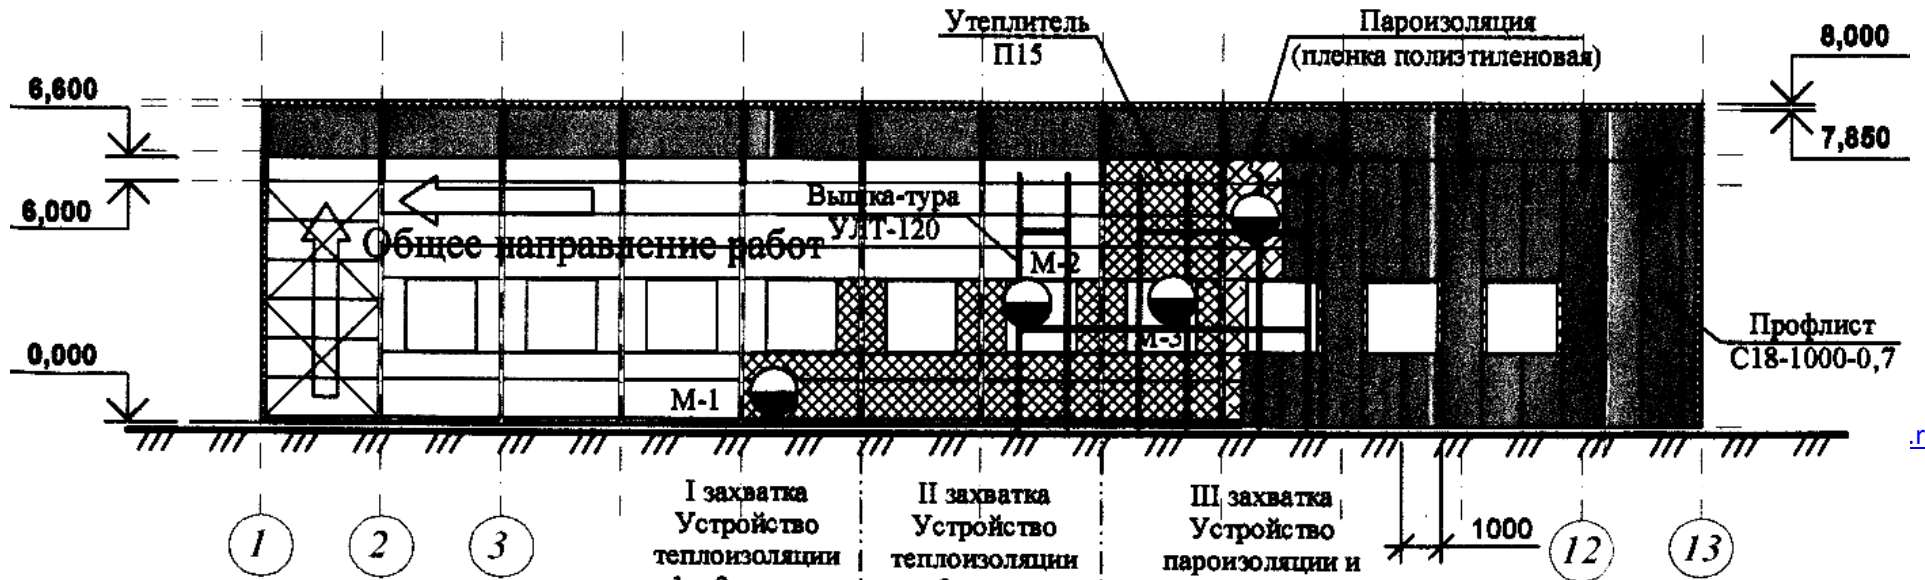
Схема организации работ по утеплению стен и монтажу внутренних профлистов (М 1:1200)
